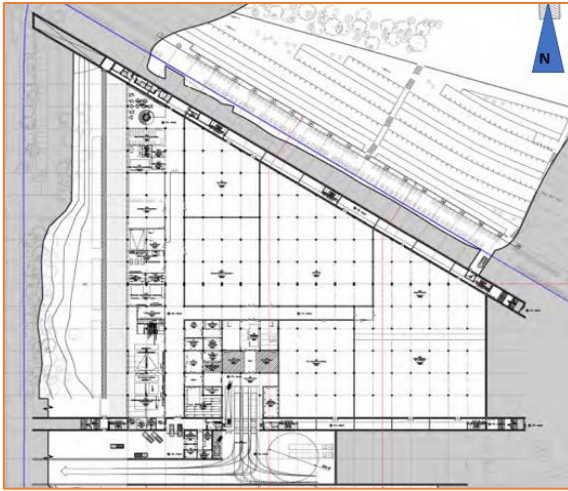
Plan de RDC de centre Louvre Liévin.
